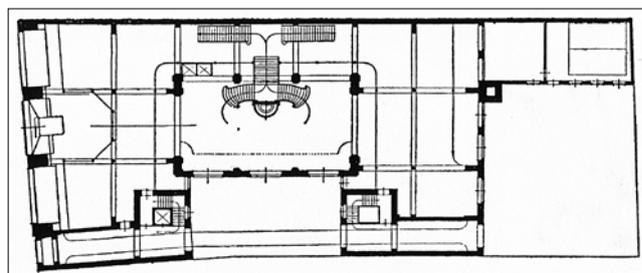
Berlin, Warenhaus Wertheim, Oranienstraße 53–54, Grundriss, zerstört
